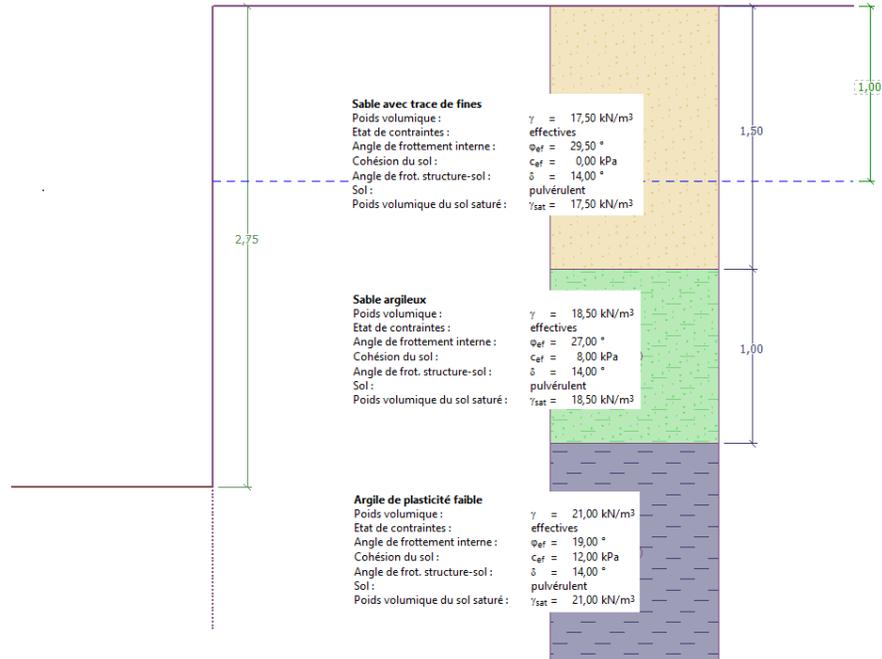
Schéma d'un mur non ancré en palplanches - Projet
